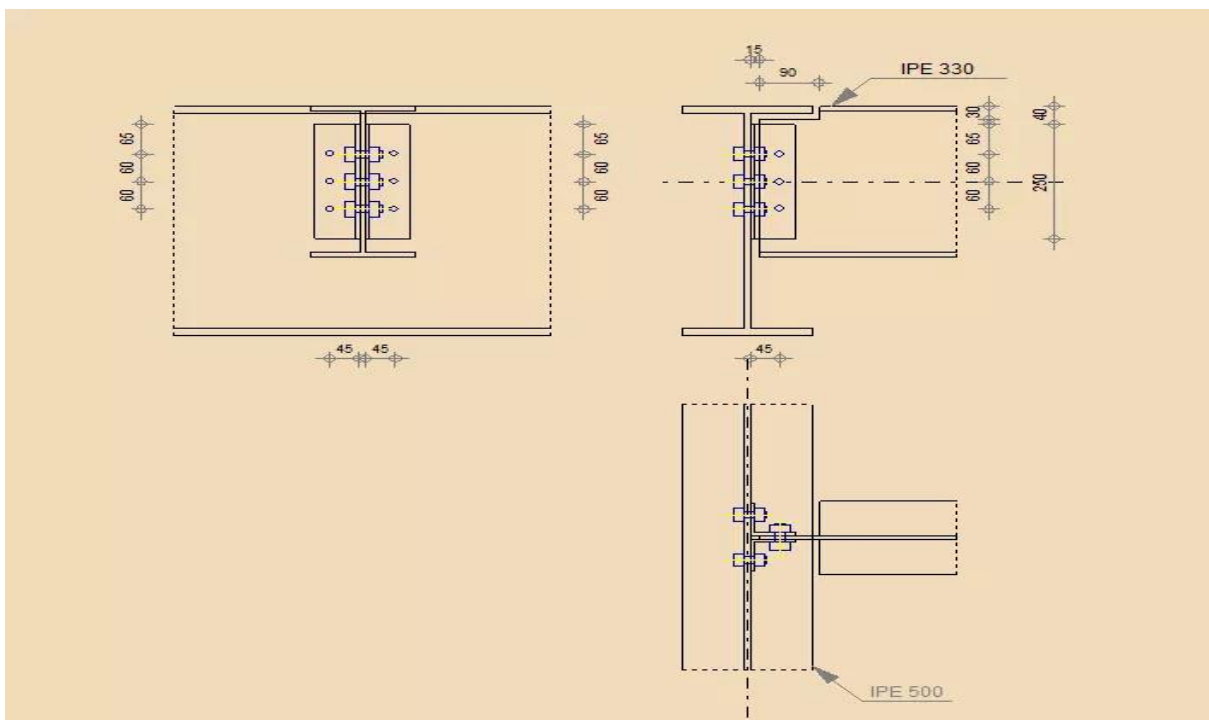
Détail d'assemblage poutre-solive (IPE500-IPE330).
